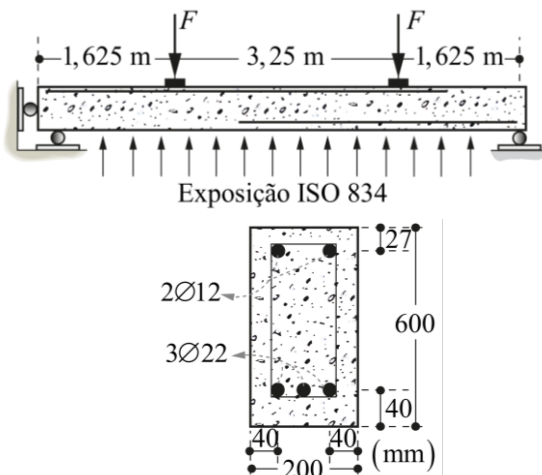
Viga biapoiada de concreto armado com carregamento externo simétrico e detalhamento da seção transversal submetida ao incêndio em três faces
